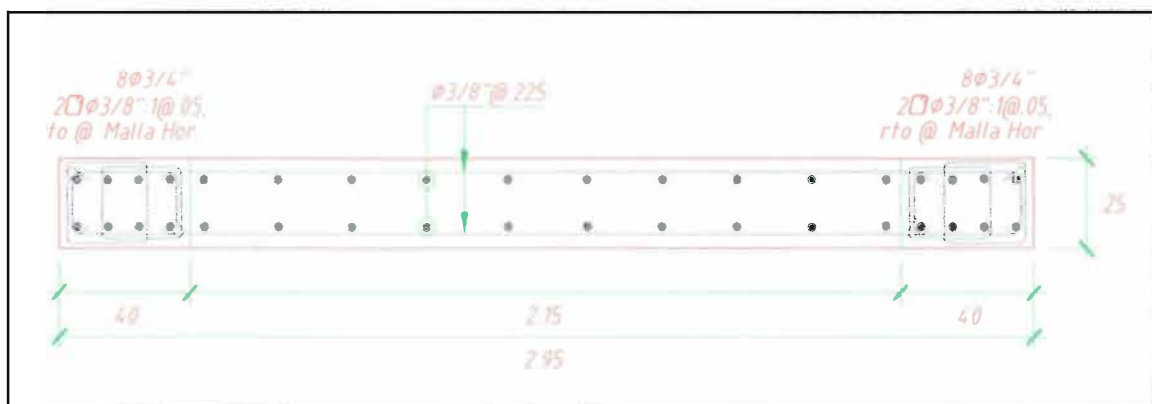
Refuerzo colocado en placa PL-03 con refuerzo final.
